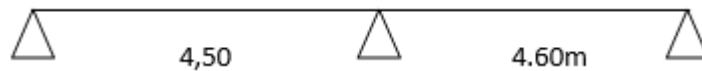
Schéma statique de la poutrelle a 2 travées.
